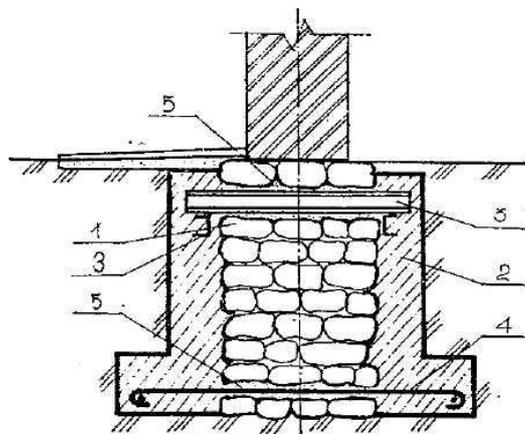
Увеличение опорной площади устройством уширения из железобетона: 1 – существующий фундамент; 2 – бетон; 3 – металлическая балка; 4 – анкер; 5 – отверстия, заделываемые цементным раствором под давлением
